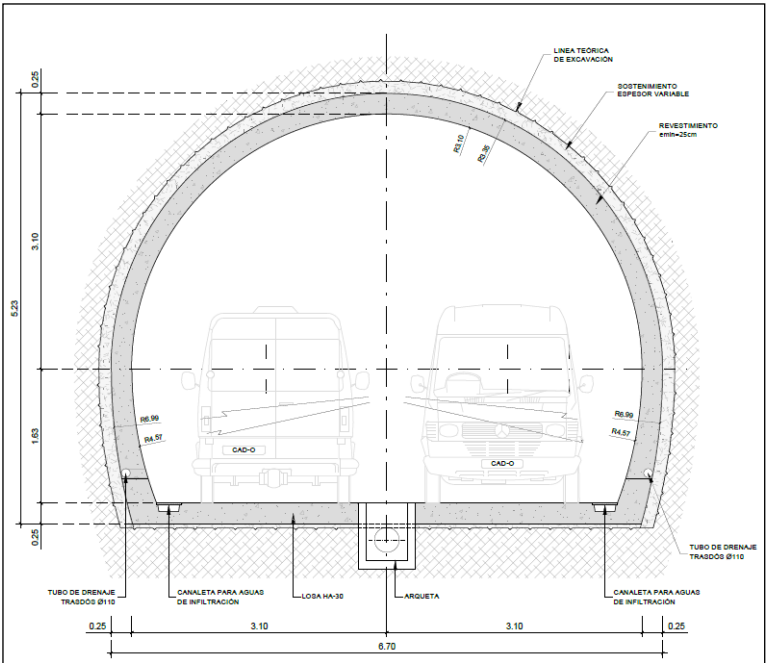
Sección tipo galería de emergencia con contrabóveda
